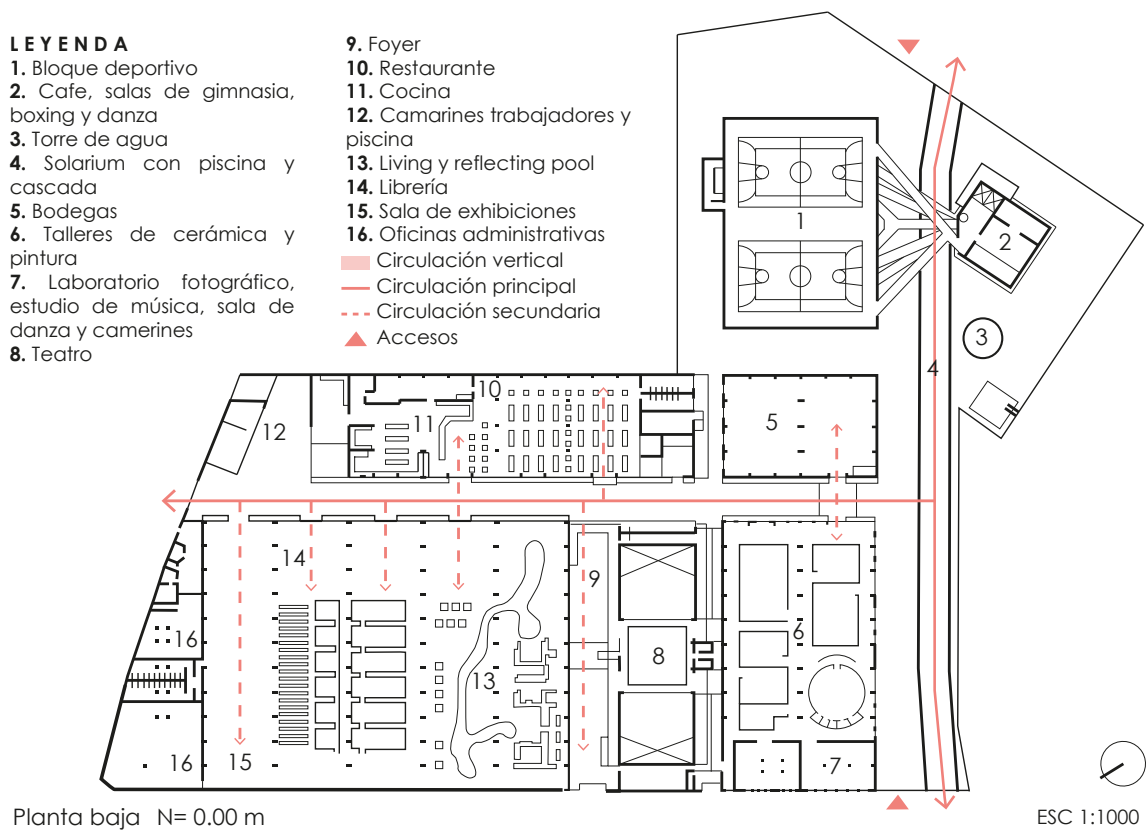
Planta arquitectónica SESC. Elaboración: Autora
